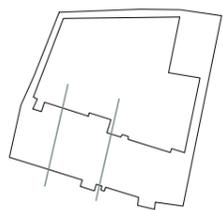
Bestandsplan, Schnitt B, M 1:150
